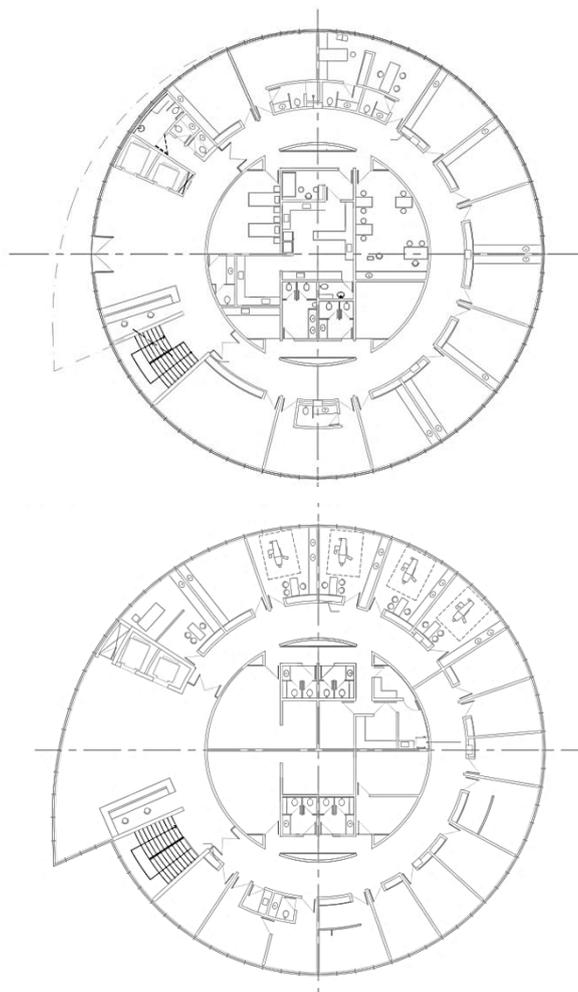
Bloco E, Planta do térreo e do primeiro pavimento. Fonte: Arquivo da PGR.
